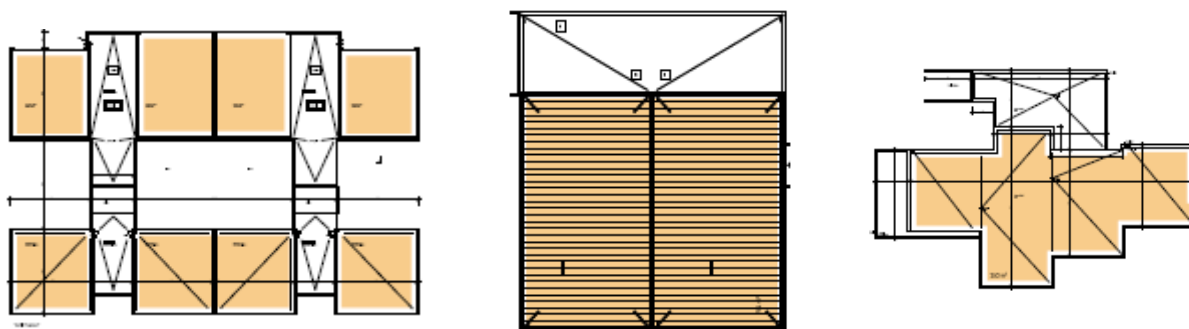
surfaces de toiture disponibles pour implantation des panneaux photovoltaïques (bâtiments B1, B2, C)
